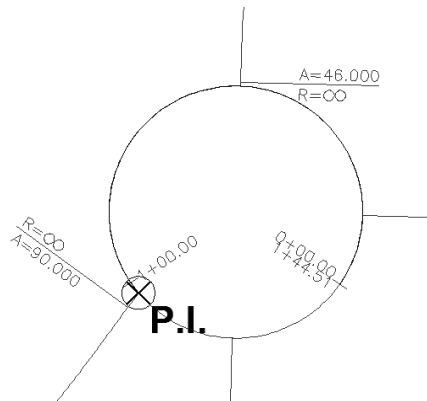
Intersecção em Planta entre o eixo do Ramo 2 e a Rotunda B
